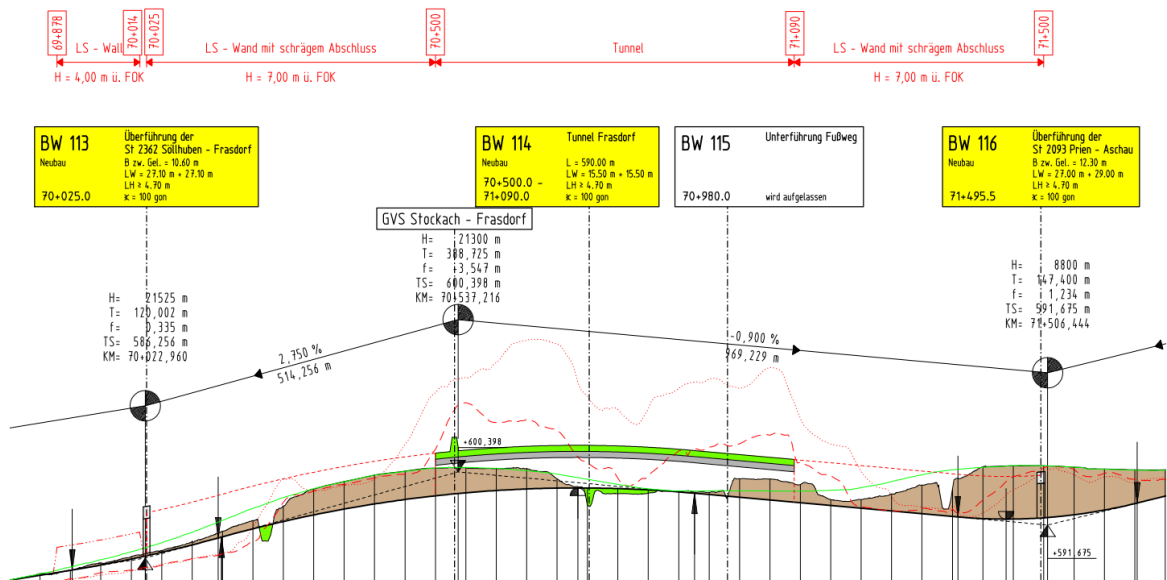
Längsschnitt des Tunnels Frasdorf
